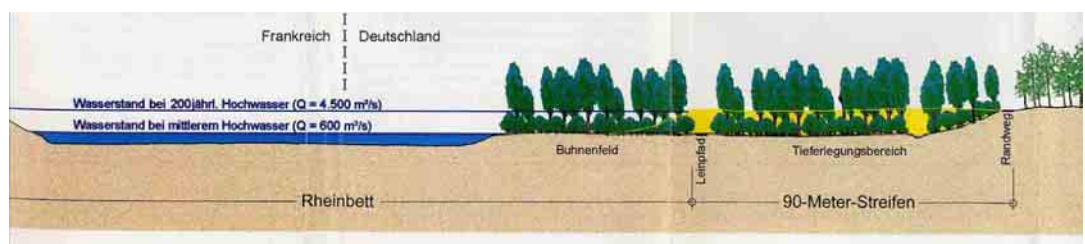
Il corso del Restrhein: la sezione dell'alveo prevista dal progetto.
